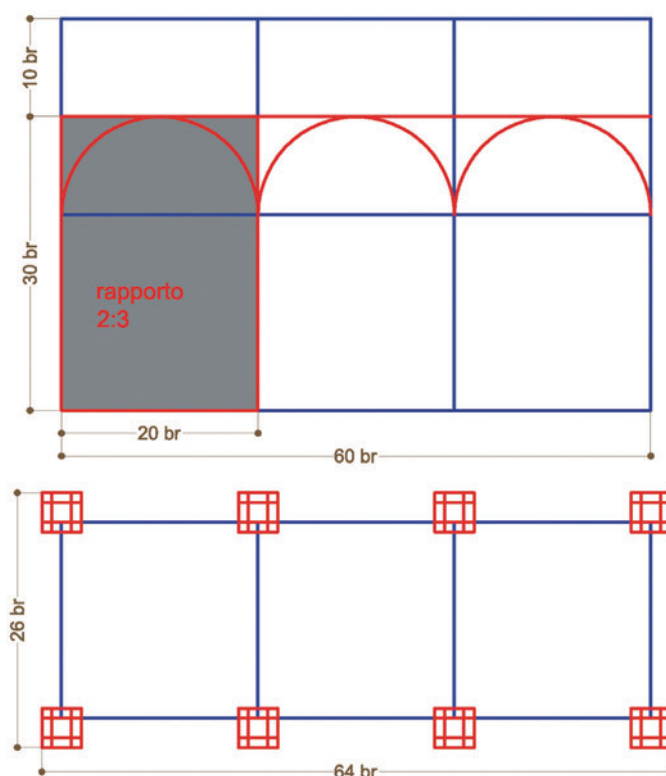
Schéma 2 du plan et de la façade de la Loggia
